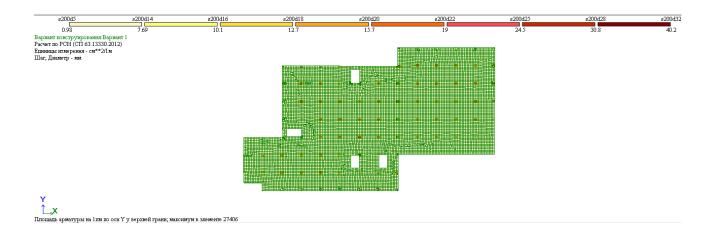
Площадь арматуры на 1 п.м по оси У у верхней грани
